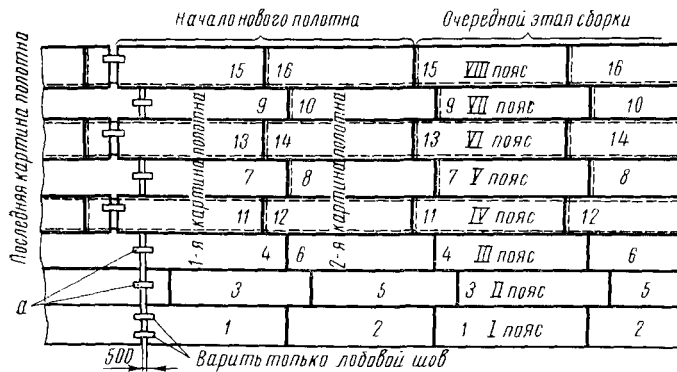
Схема сборки первой и второй картин полотнища:
